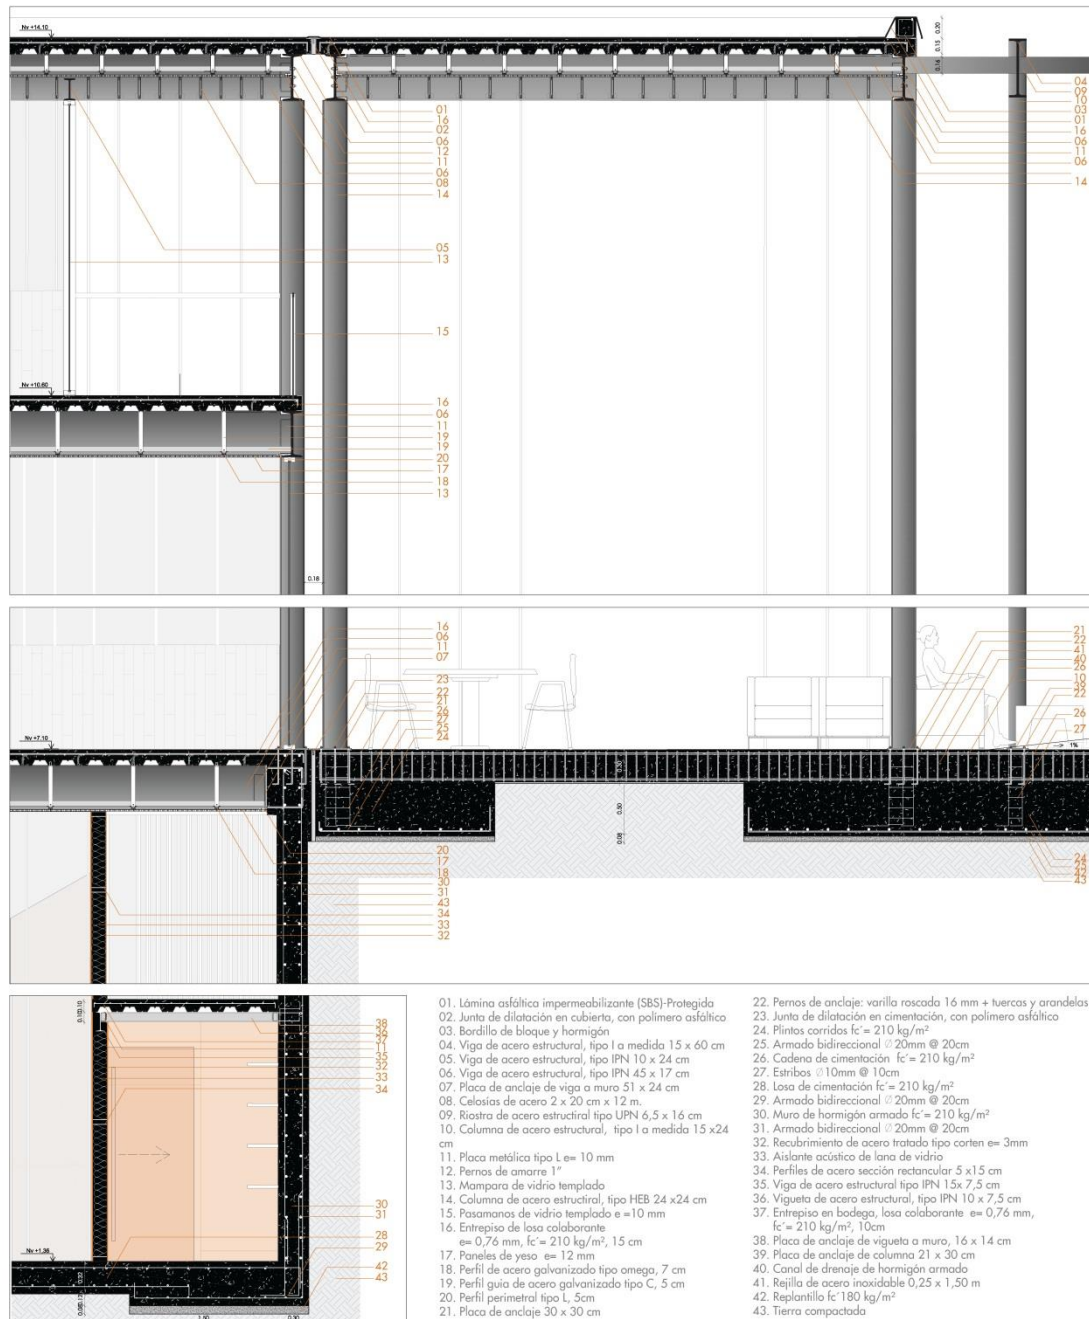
Corte por muro bloque elevado (Suárez A., 2017)
